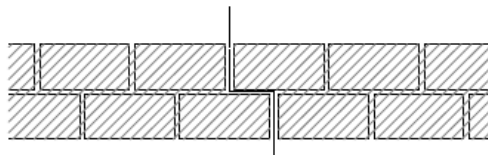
Junta de dilatación con solape. Esquema en planta
